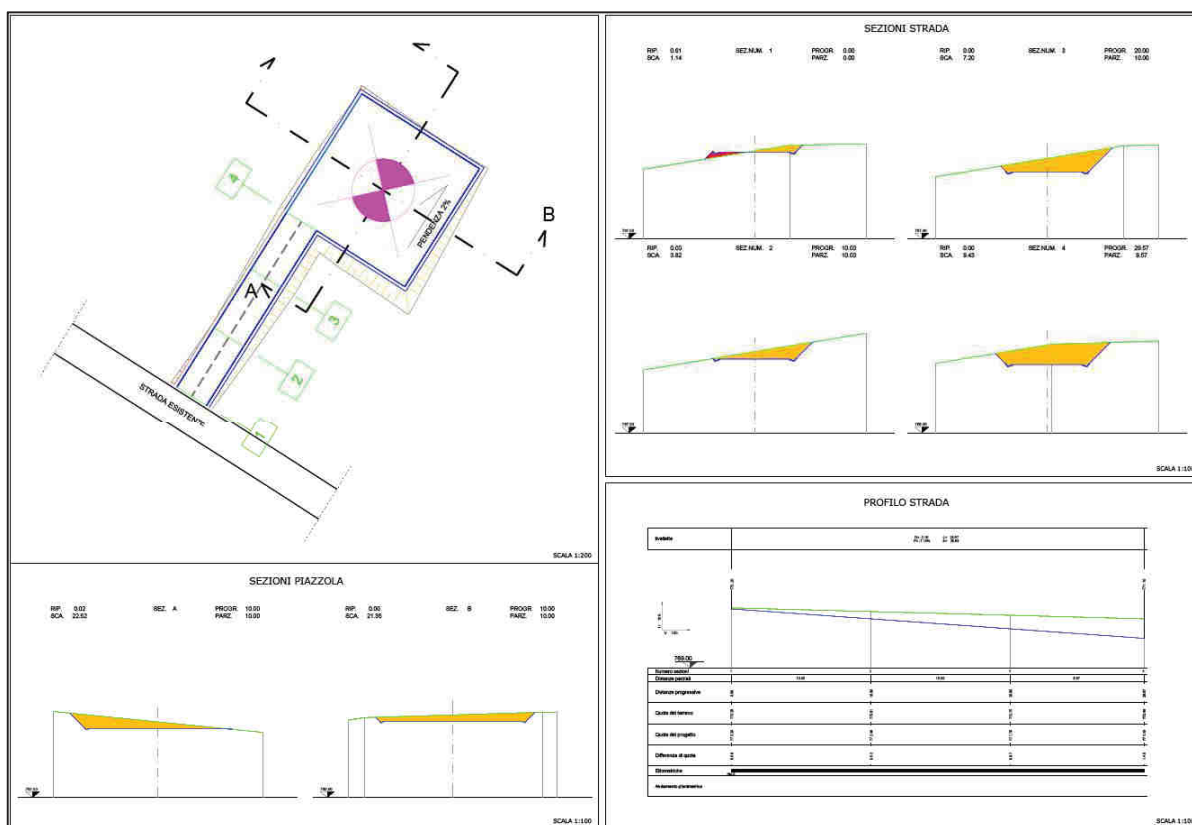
Pianta, sezioni e profilo strada e piazzola CS01 (fase di esercizio).
